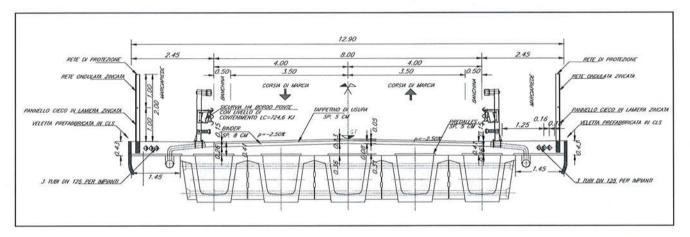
Sezione tipo cavalcaferrovia campata. L=25.00 m
